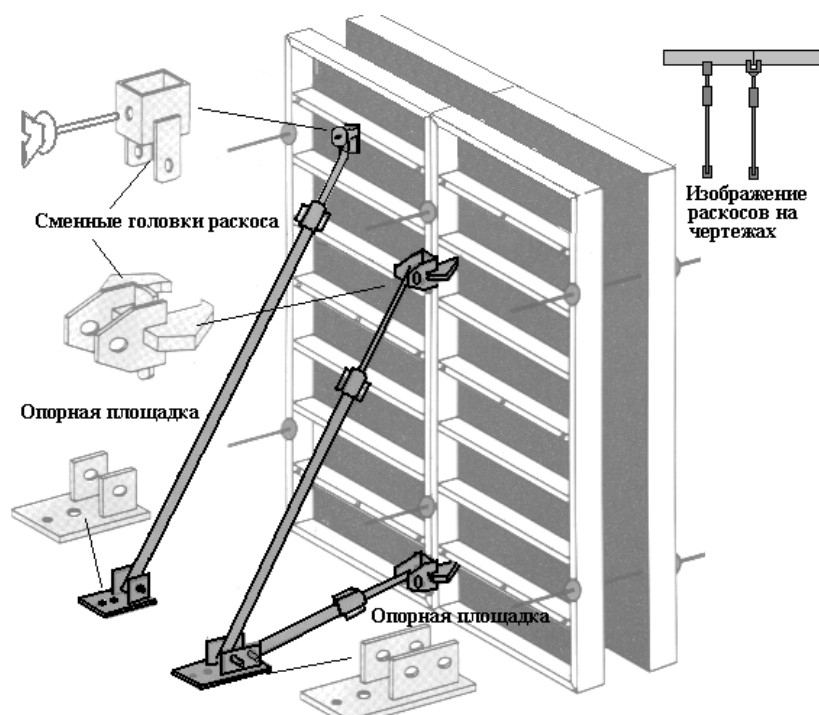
Узлы раскрепления вертикальной опалубки
